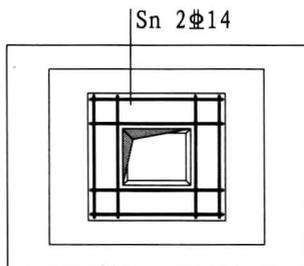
单杯口独立基础顶部焊接钢筋网示意
